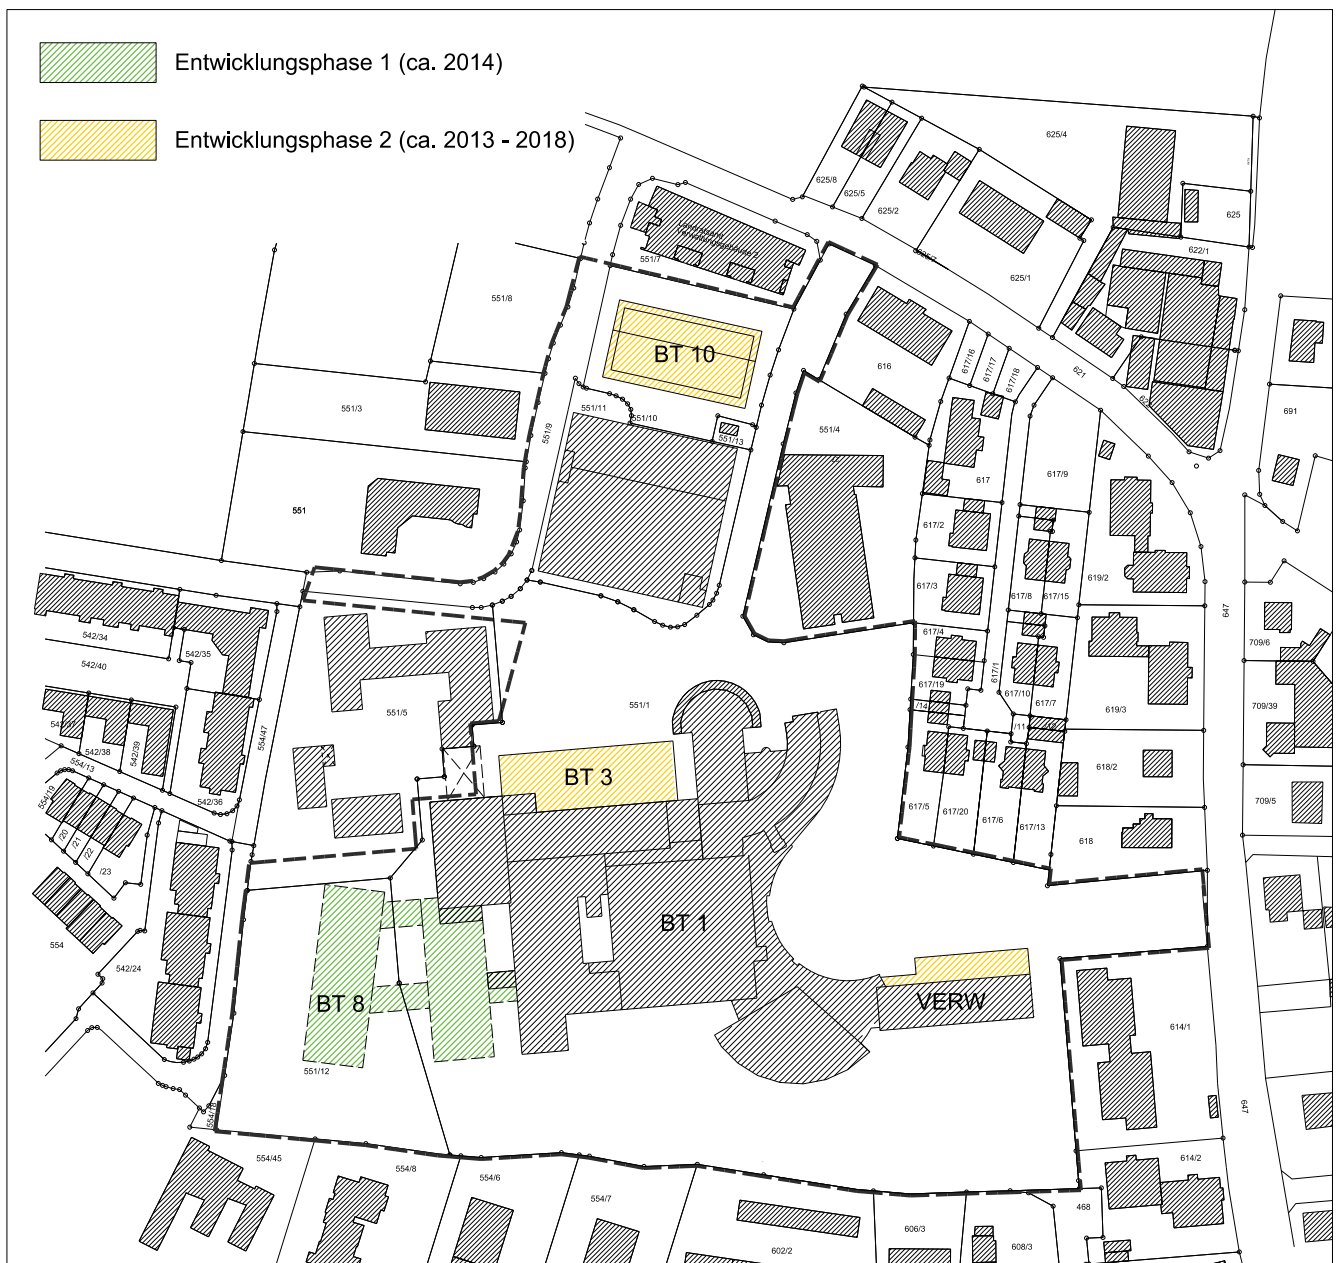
Lageplan Entwicklungsphasen, ohne Maßstab
